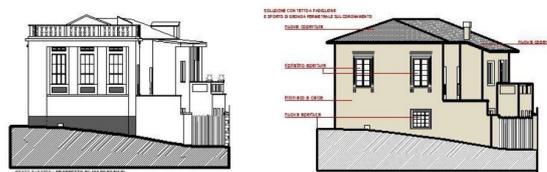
Confronto tra il prospetto attuale su via Coppito e quello prima dell'intervento del 1934
